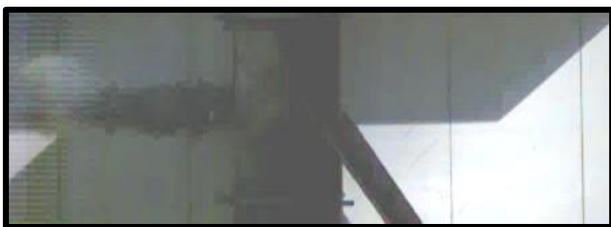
ภาพถ่ายความเร็วสูงของการวิบัติ แบบ Penetration + back spalling
